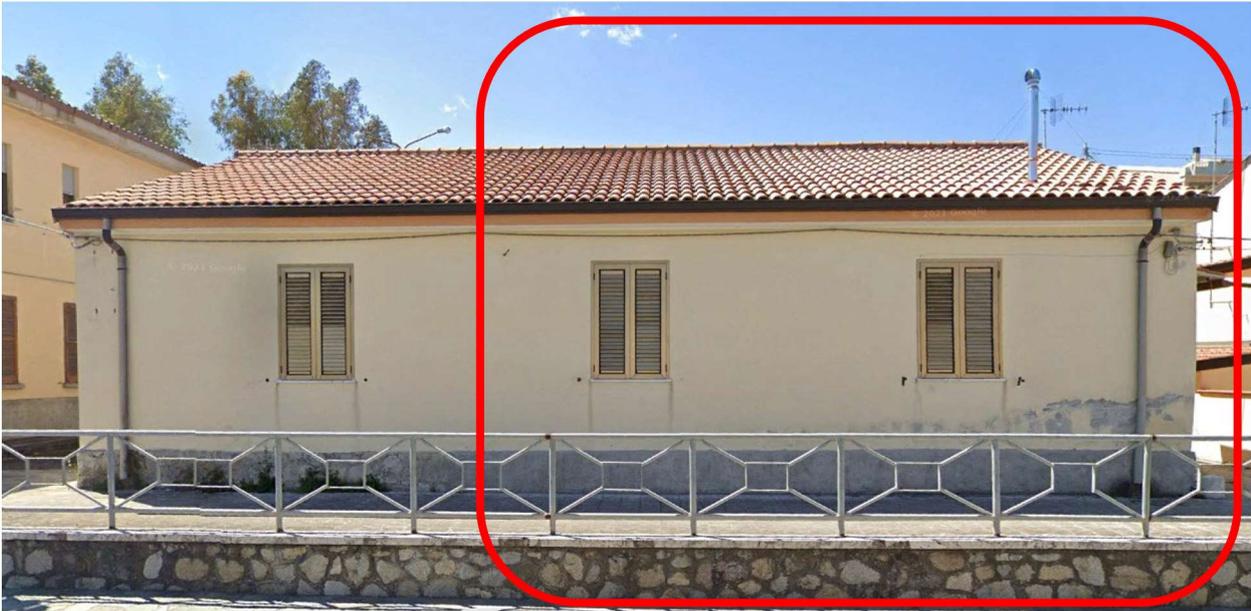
Foto vista lato Est (S.S. 106 Jonica)
